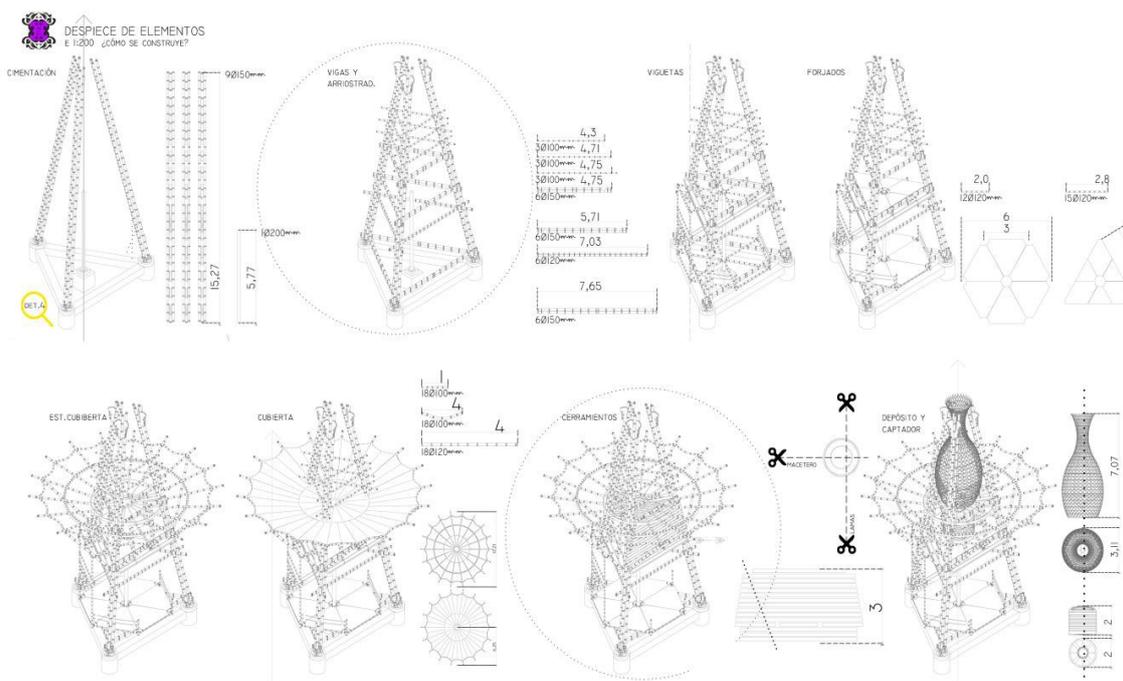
Fotogramas elaborados por el alumno Rodrigo Castroviejo para realizar la animación de la ejecución constructiva de un proyecto arquitectónico
